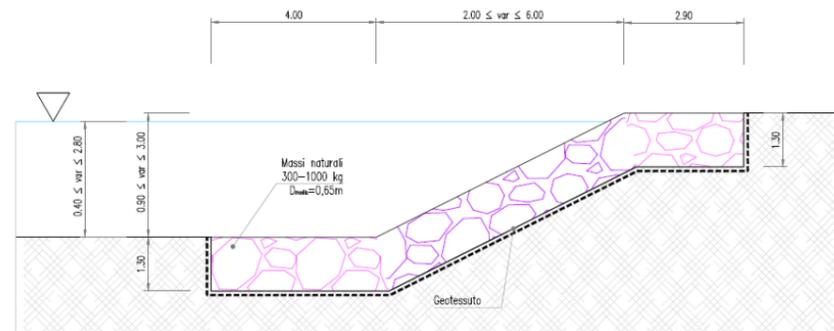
Stralcio Elaborato T00ID01IDRDI03_A: Sezione di stabilizzazione e protezione delle sponde con massi naturali
